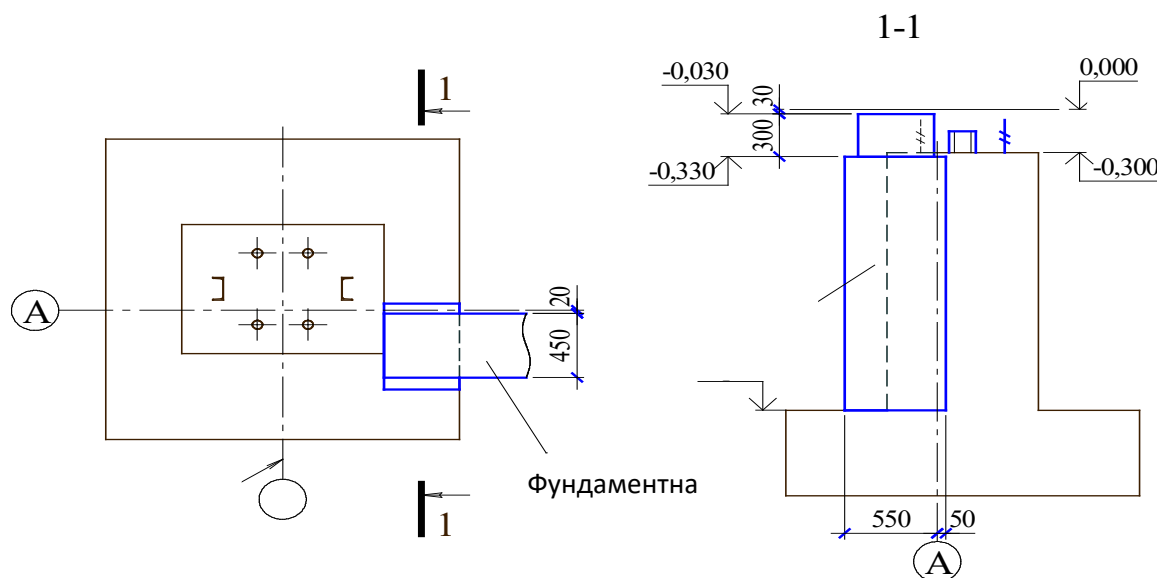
Схема обпирання фундаментної балки на фундамент по осі А
